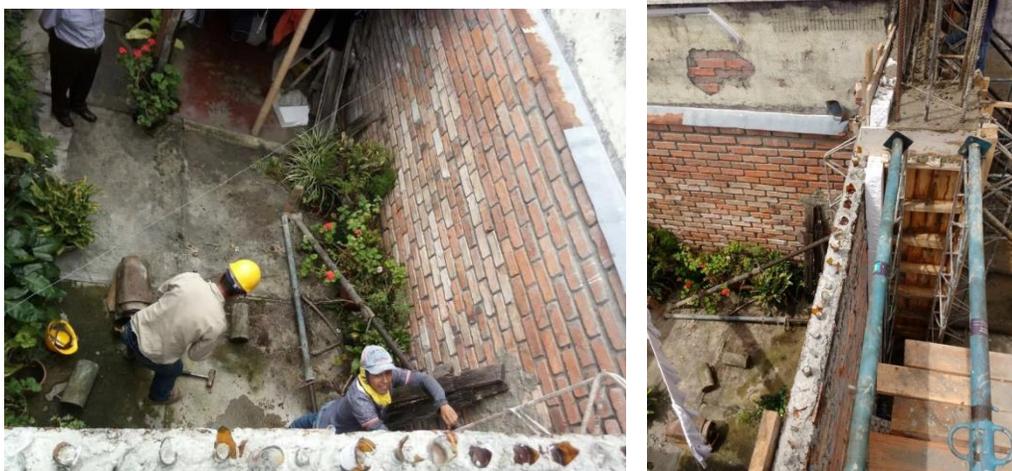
Refuerzo para muro de casa aledaña. Fuente: tomada por pasante.
